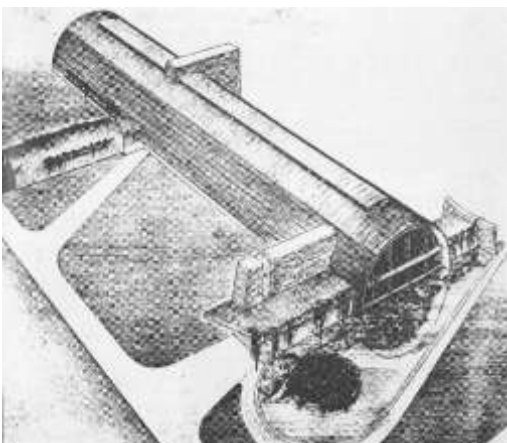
Camp Parks, Seabee Chapel - Planimetria e fotografie dell’edificio
